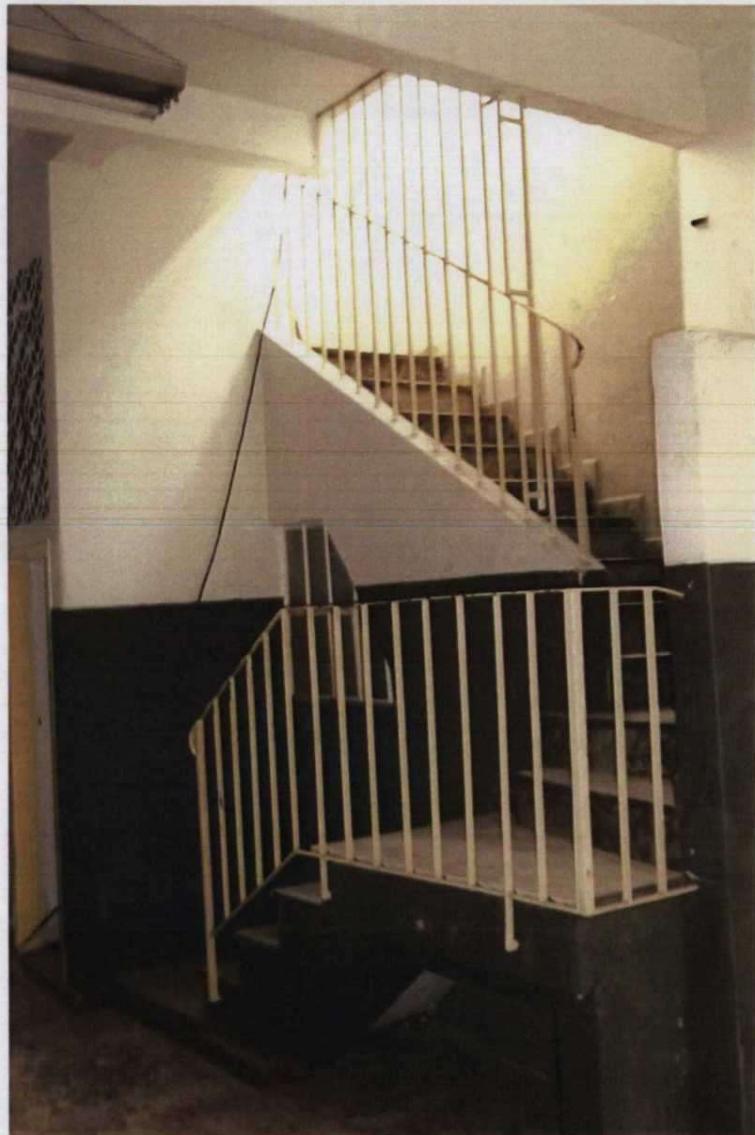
PERSPECTIVA DA ESCADA QUE ACESSA O PAVIMENTO
